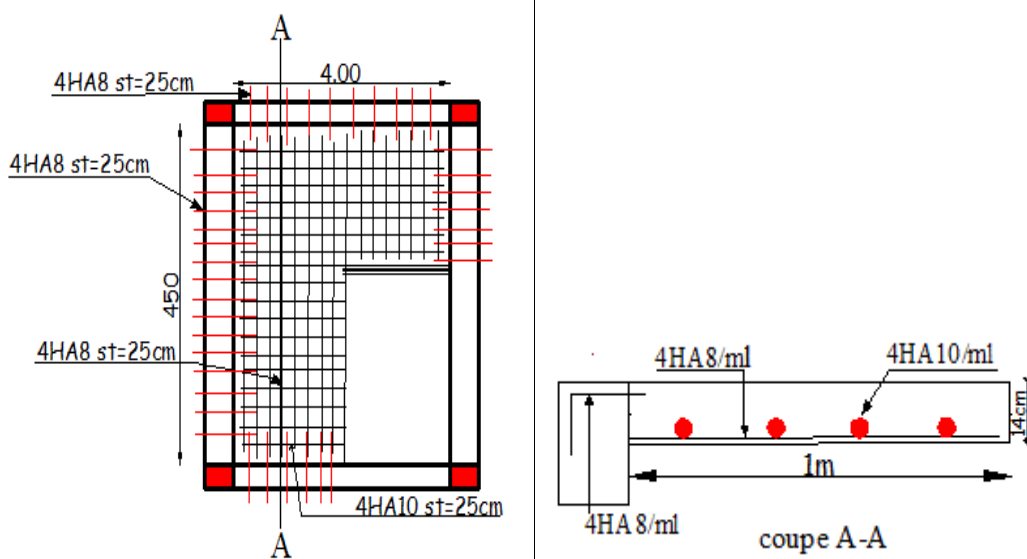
schéma de ferrailage de la dalle 1 et sa coupe A-A.
